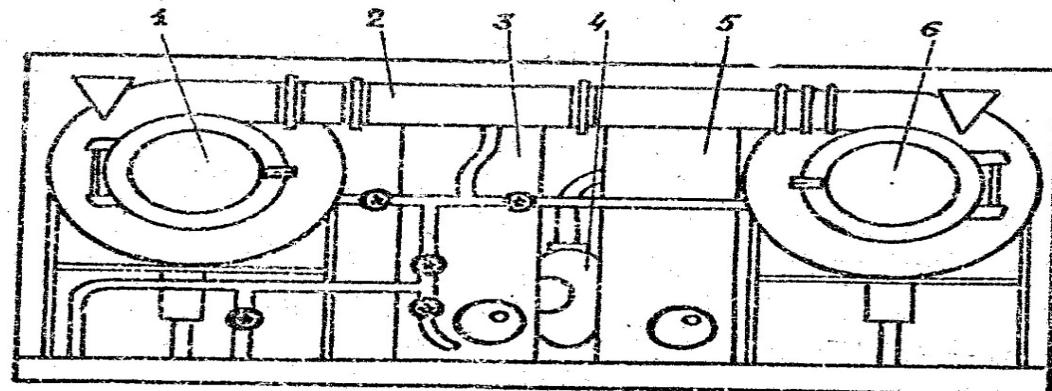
Компоновка оборудования прачечного агрегата:
